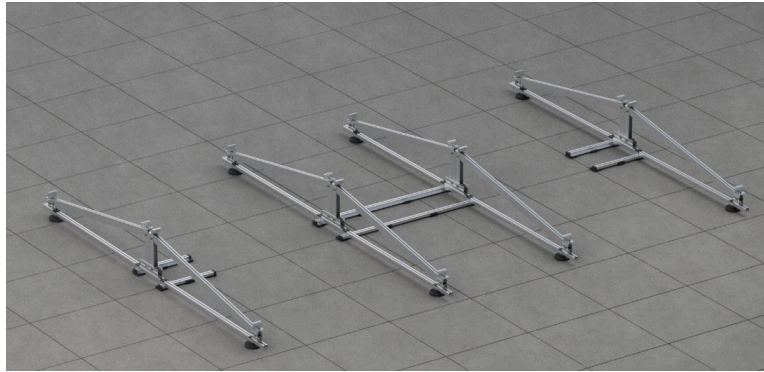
Suportes utilizados na estrutura metálica para terraço plano com configuração nascente-poente [52]
